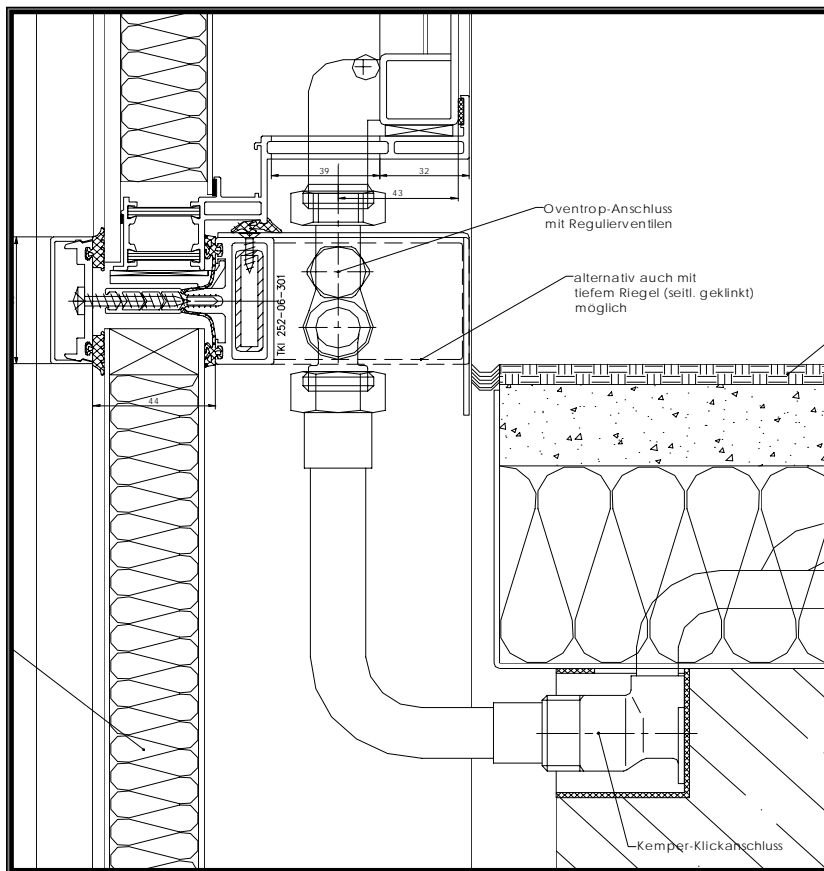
Detail aus Vertikalschnitt am Beispiel einer 50 mm Fassade, System TKI, Serie 252, Klick-Anschluss und Oventrop-Ventil
